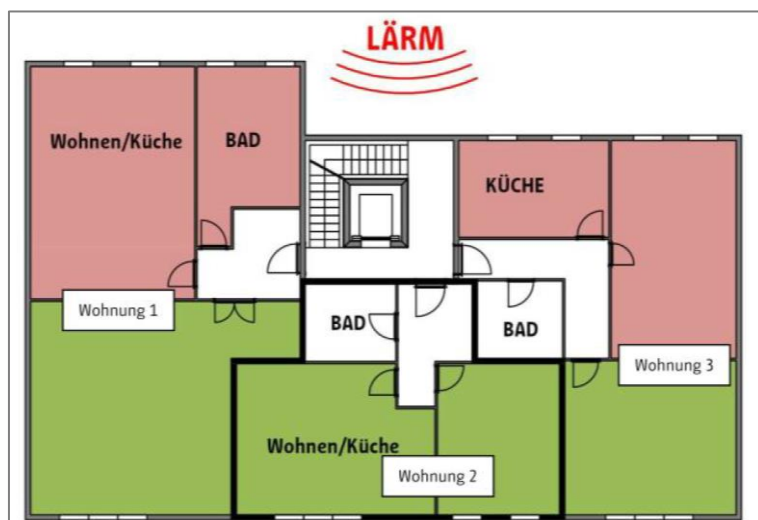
Prinzip der Grundrissregelung (Berliner Leitfaden Lärmschutz in der Bauleitplanung, Mai 2017, zit. n. Goritzka Akustik 2023, S. 19)
